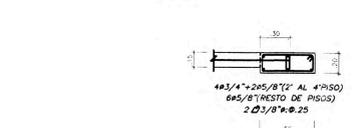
DETAILLE DE DOBLADO DE ESTRIOS EN COLUMNAS Y VIGAS
